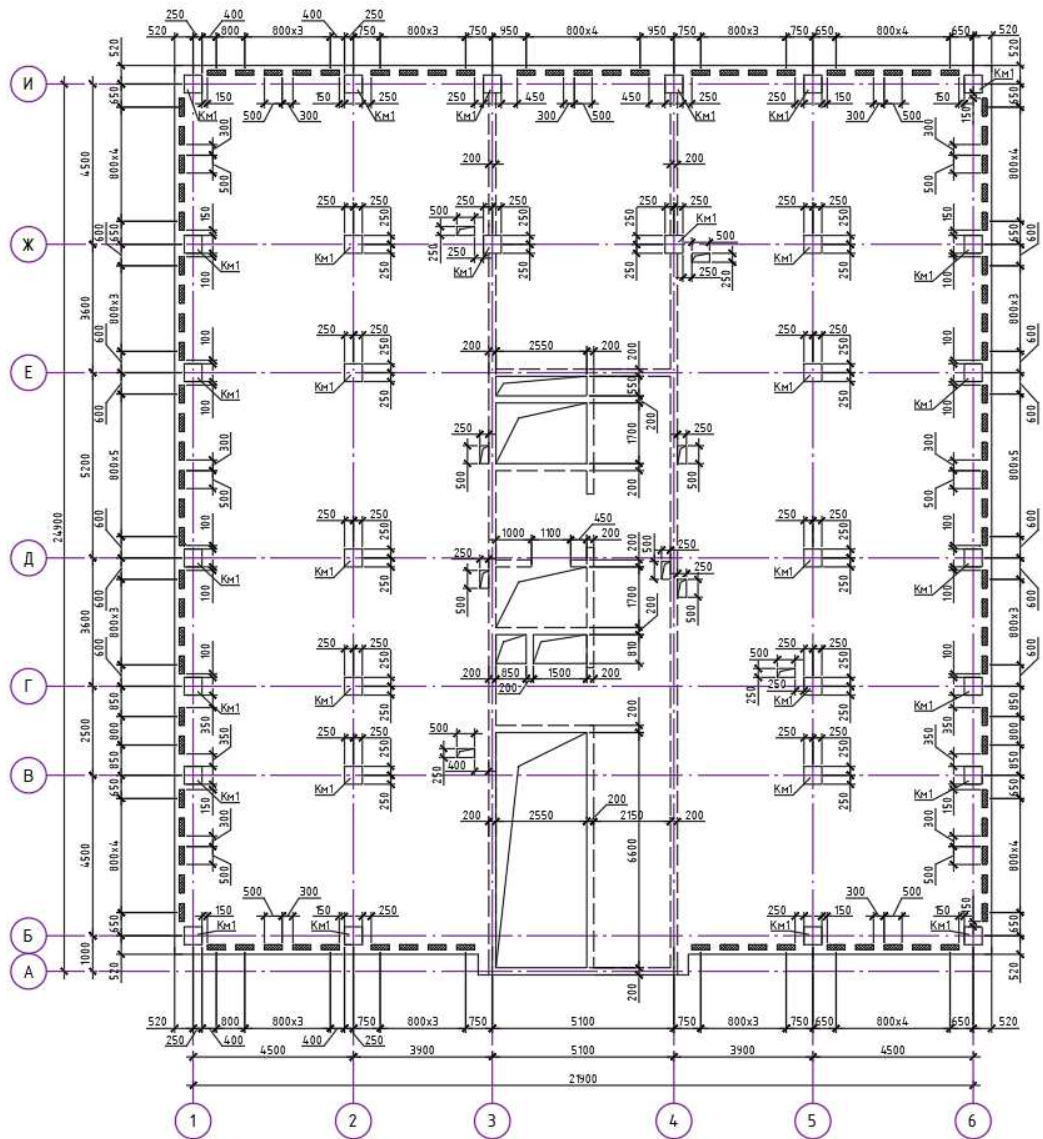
Рассматриваемая плита перекрытия первого этажа
